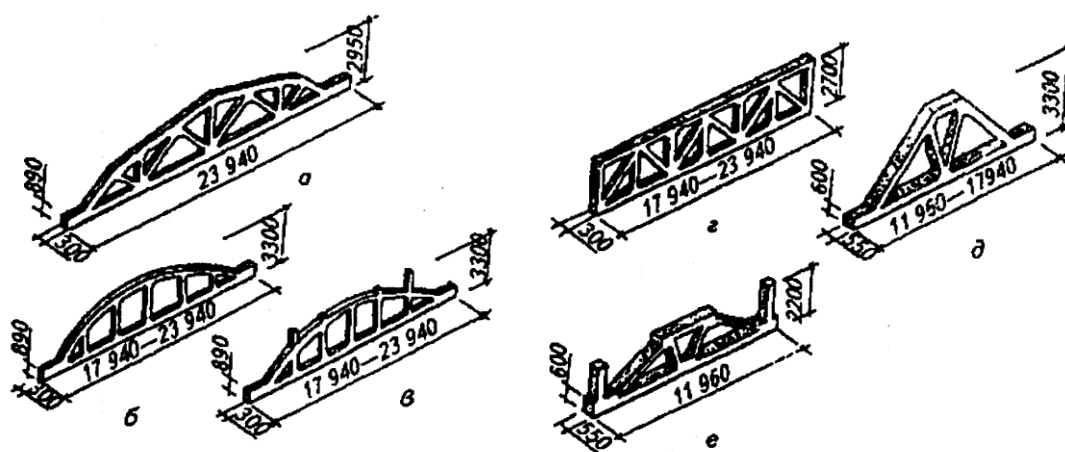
Железобетонные фермы покрытия: *а* - сегментная; *б* - арочная бескаркасная; *в* – арочная для плоских покрытий; *г* - с параллельными поясами; *д* - трапецидальная; *е* – подстропильная
